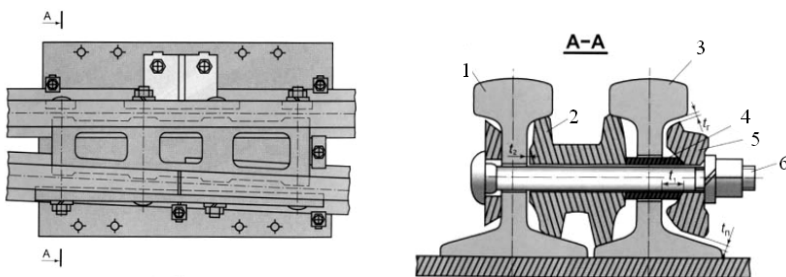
Конструкция корневого крепления остряка вкладышно-накладочного типа:
